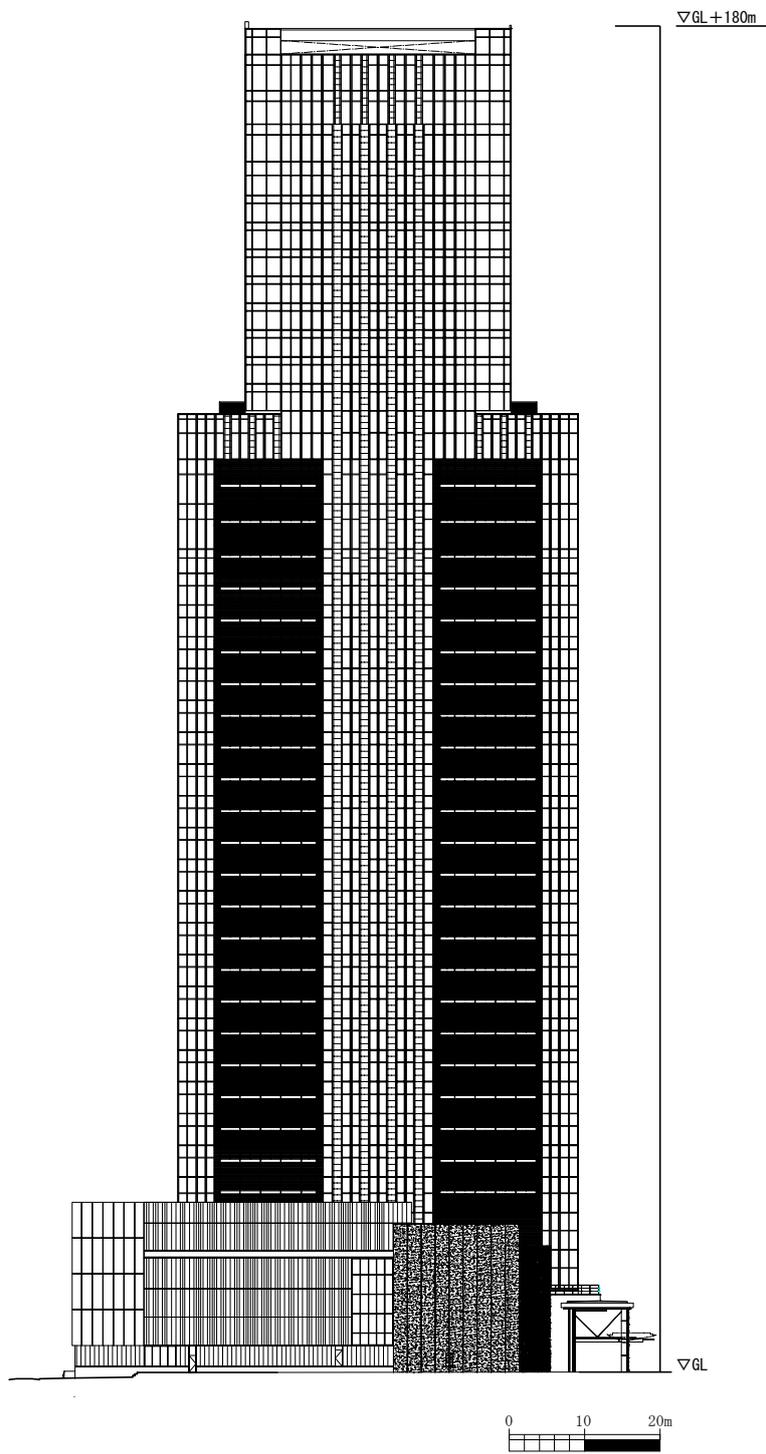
(5) 計画建築物立面图 (南侧) (完成(竣工))
